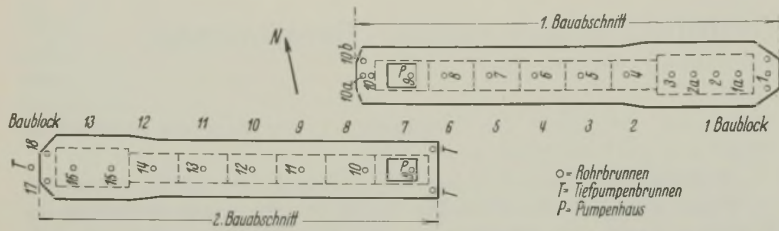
Ausführung des Dükers in zwei Bauabschnitten.
